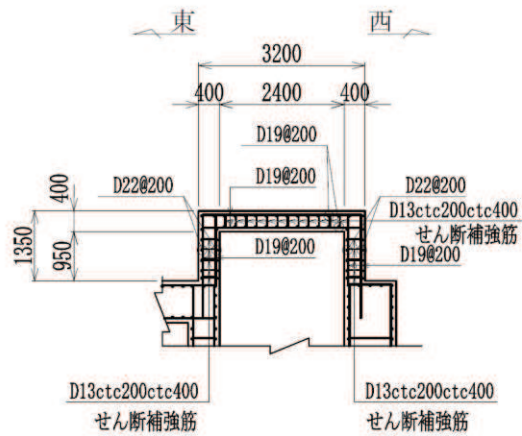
(6) 復水貯蔵タンク基礎 概略配筋図 (5-5 断面)
